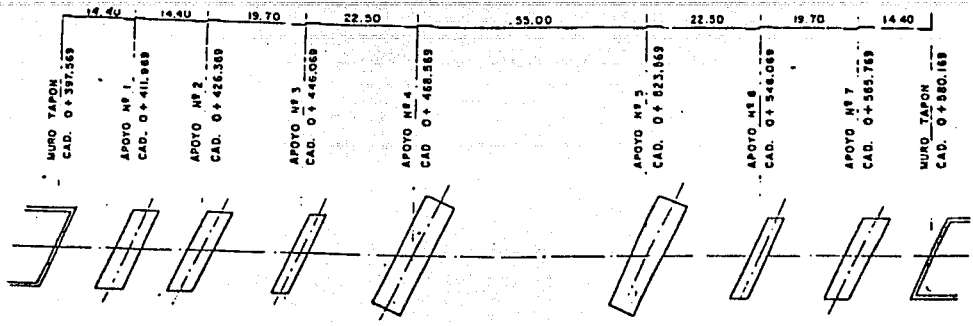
PLANTA LOCALIZACION DE APOYOS.
